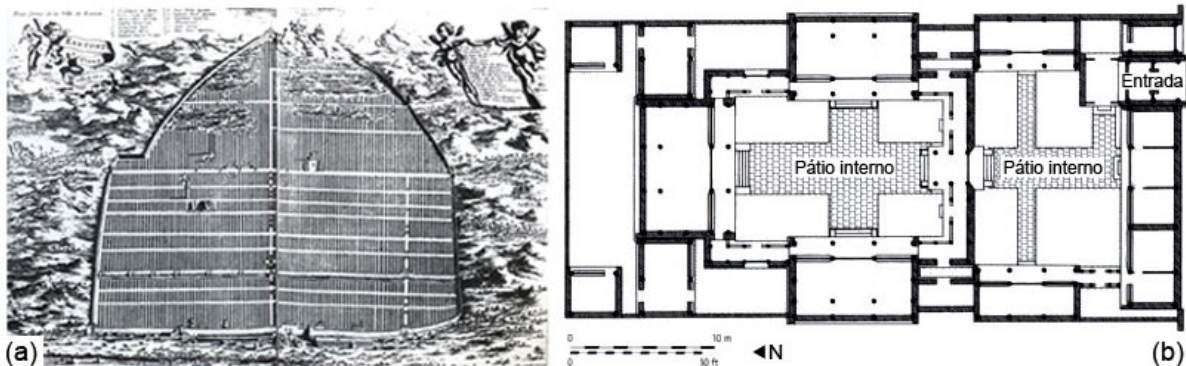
(a) Planta da cidade de Cantão,1668; Planta de casa típica da cidade de Beijing, China. Século 15 d.C.
